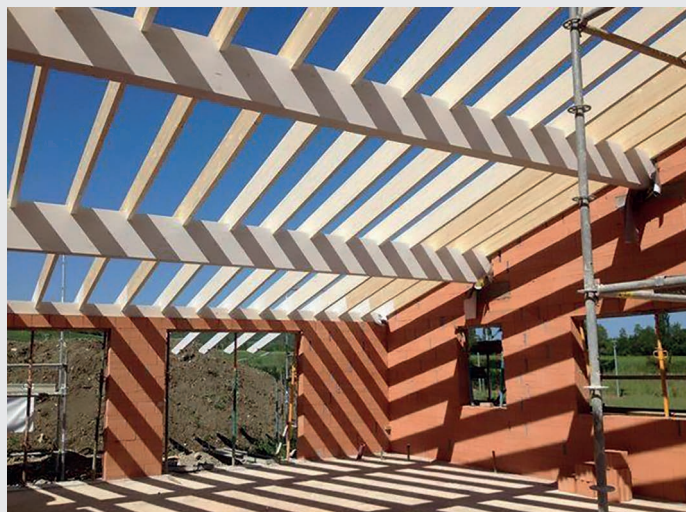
Encuentro de una estructura de madera con los muros de bloque Termoarcilla rectificado.
